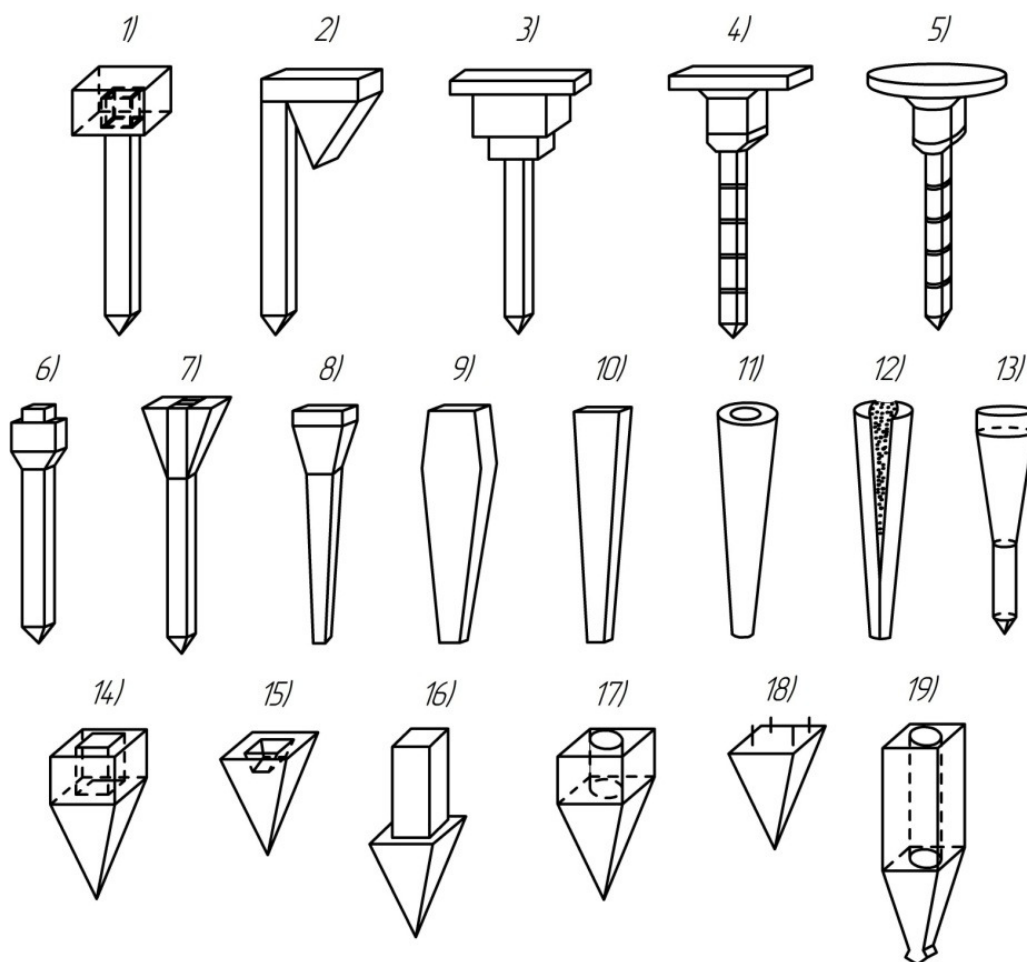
Виды готовых и набивных железобетонных свай с уширениями сверху и наклонными боковыми гранями:
